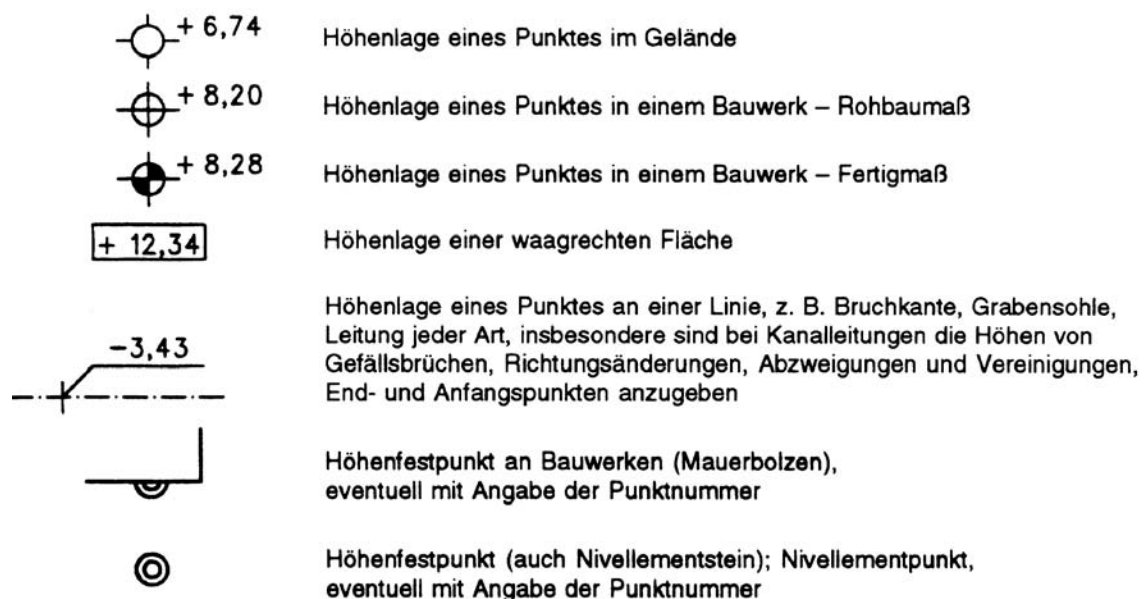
Höhenangaben in Grundrissen (Beispiele)
